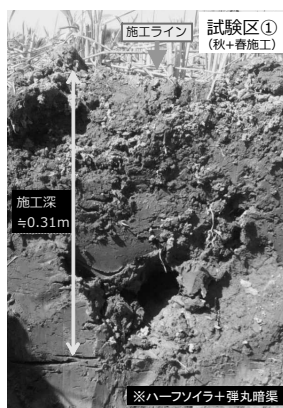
施工5ヶ月後の断面 (H29 春施工 弾丸孔・亀裂確認可)
